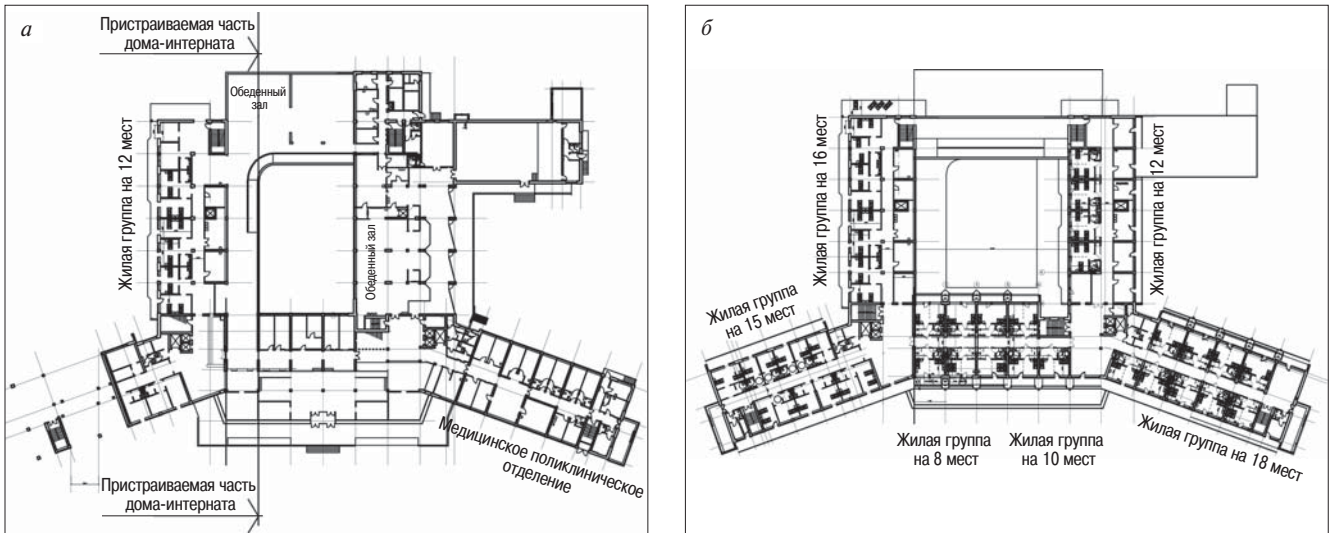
Реконструкция дома-интерната для престарелых и инвалидов № 1 (Санкт-Петербург): а – план 1-го этажа; б – план 2-го этажа
